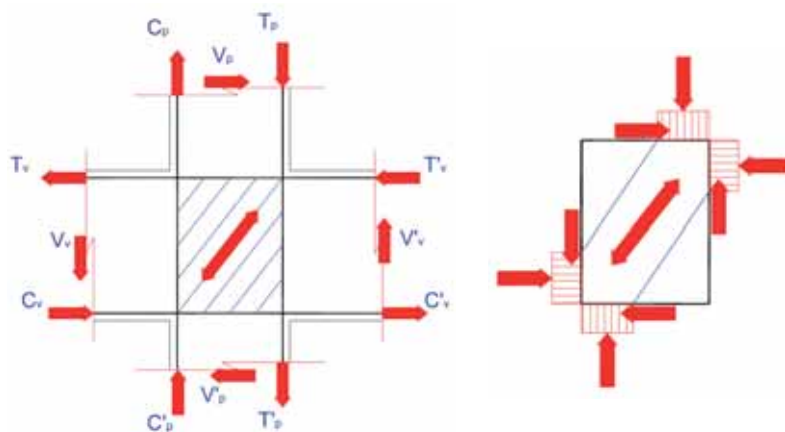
Mecanismo de transmisión de las cargas en un nudo viga-pilar.
